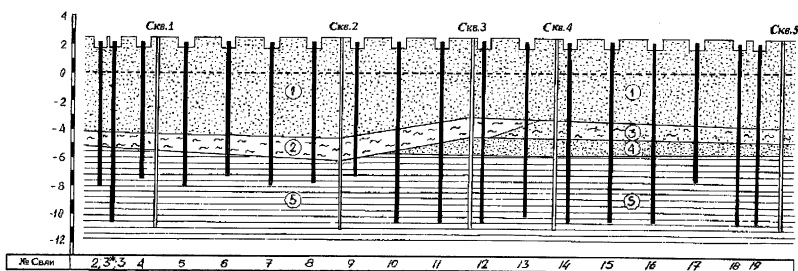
Геологическое строение со схемой расположения свай по продольной оси
